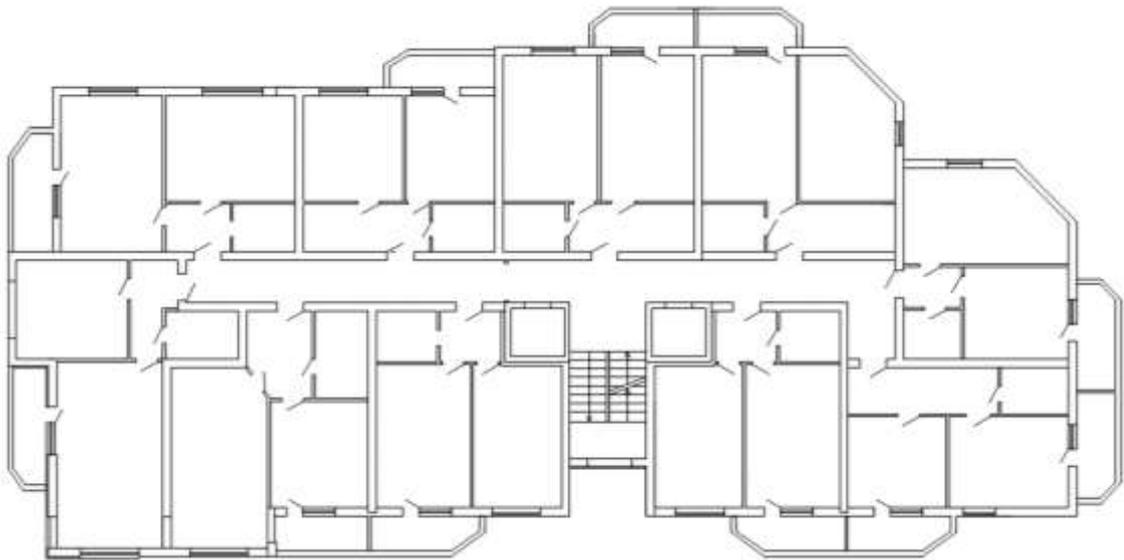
Планувальне рішення 2-го поверху будинку.
